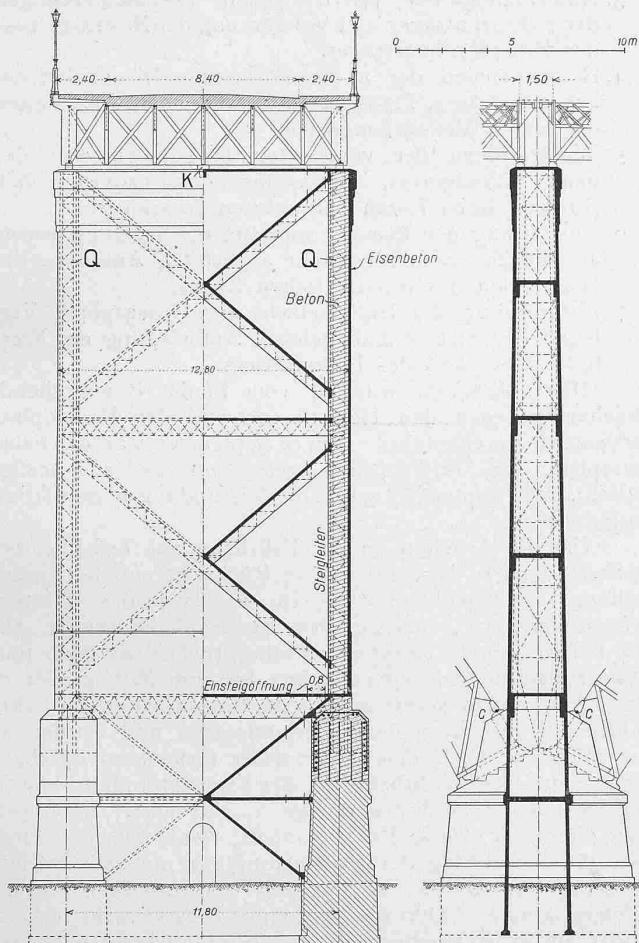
Aussteifung des Hauptpfeilers 8 mittels Eisenbetonverkleidung. — Masstab 1:300.
